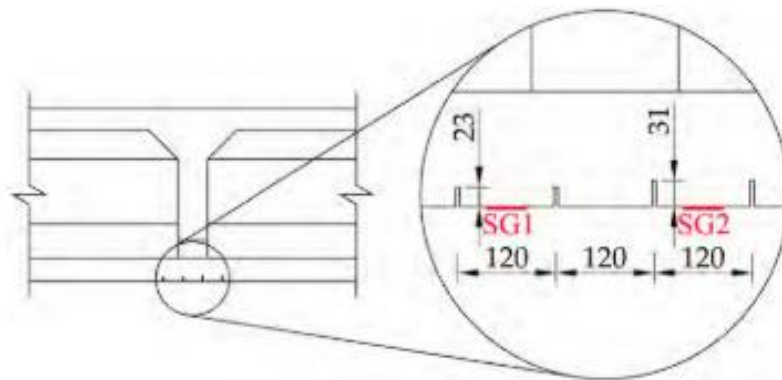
Parámetros seleccionados para el ensayo Plano en alzado de la sección a estudiar. (Fuente: Kralovanec, Moravčík, et al., 2021)
